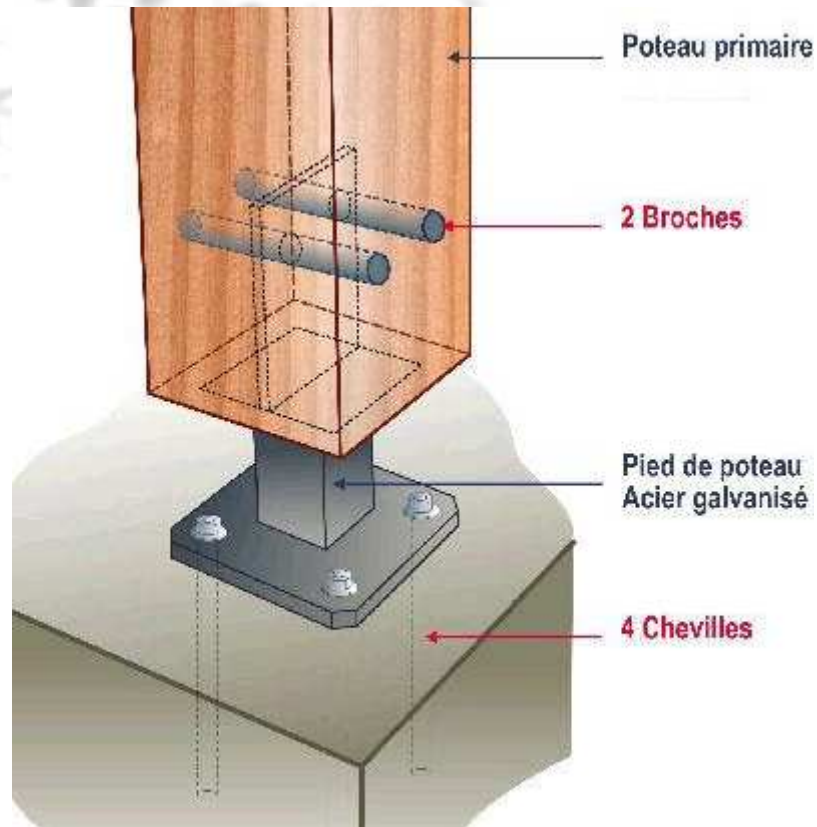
Liaison poteau fondation.(www.certu.fr)
